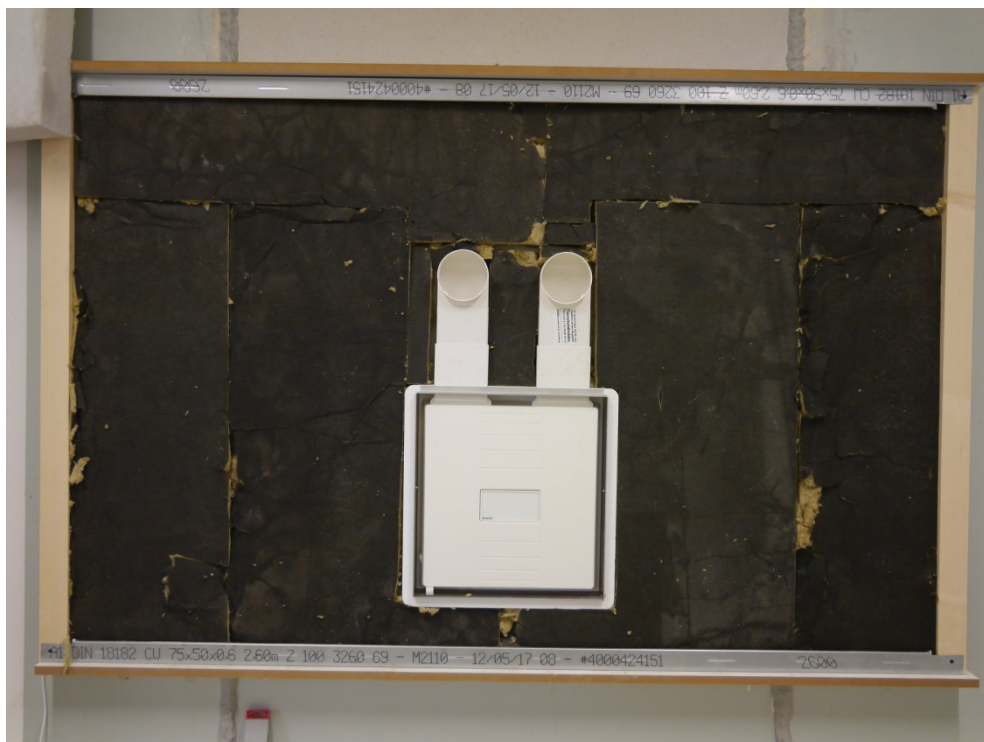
Einbauvariante U<sup>2</sup>: Raumseitige Ansicht Lüftungsgerät mit montierten Lüftungskanälen für Standardeinbau Ein-Raum-Variante, Zustand vor dem Schließen der Vorsatzschale.
